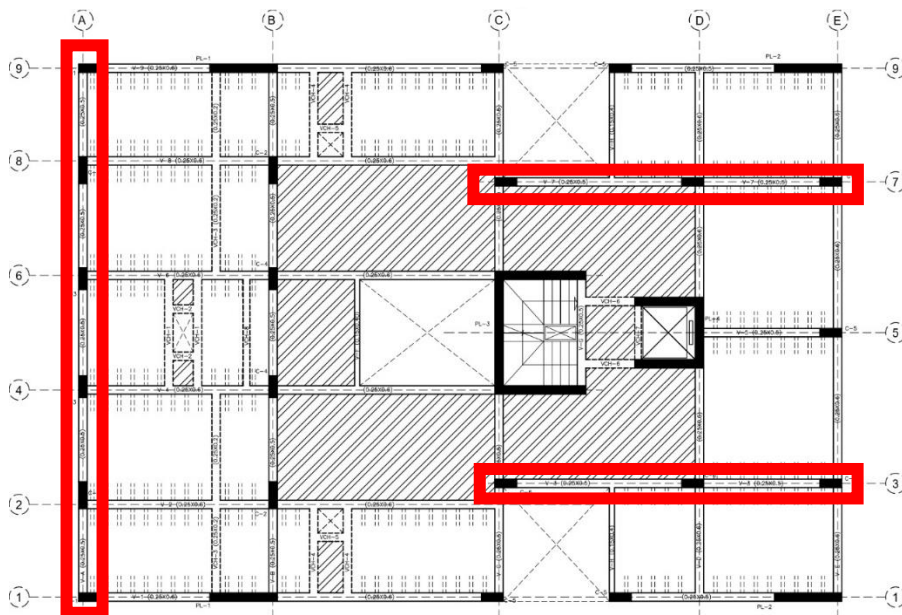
Viga V-3, Viga V-7 y Viga V-A
